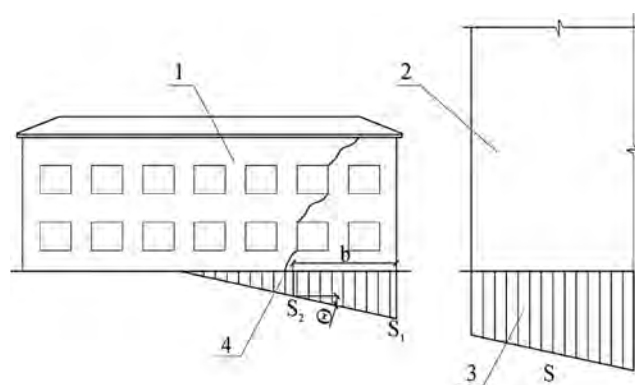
Крен фундаментів будівель, що знаходяться в зоні впливу новобудови: 1 – існуюча будівля; 2 – новобудова; 3 – епюра осідань новобудови; 4 – епюра додаткових осідань існуючої будівлі
